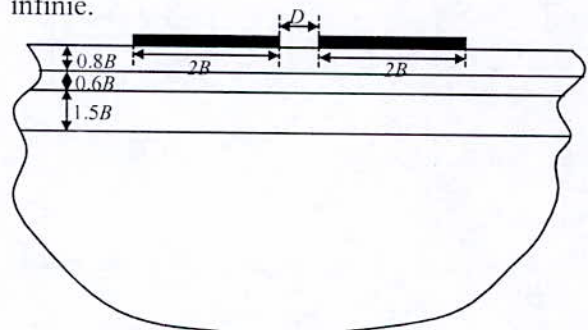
Système fondation-sol-fondation: cas d'un profil de sol multicouche
